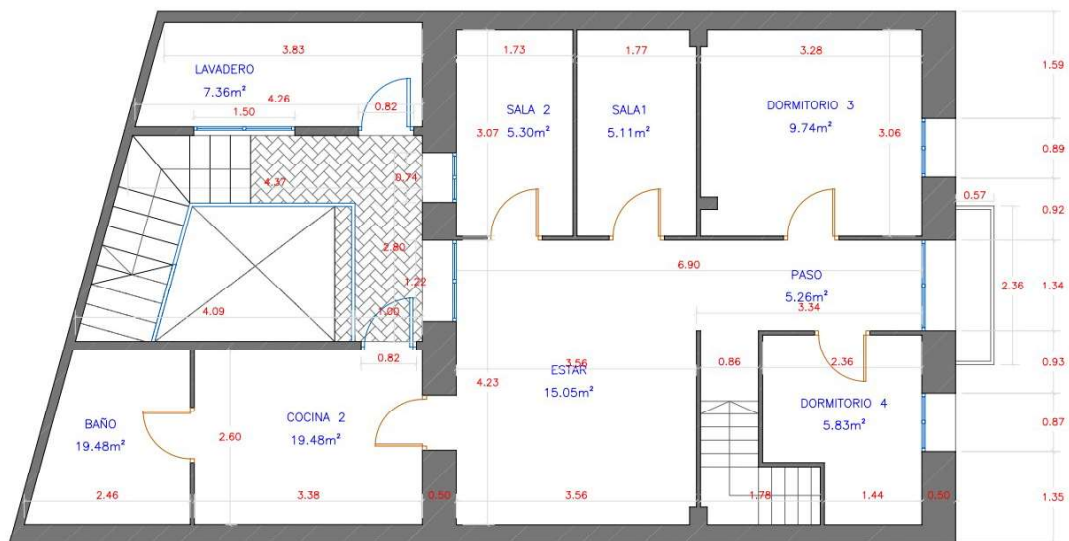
Estado inicial de la planta primera (proyecto básico)
